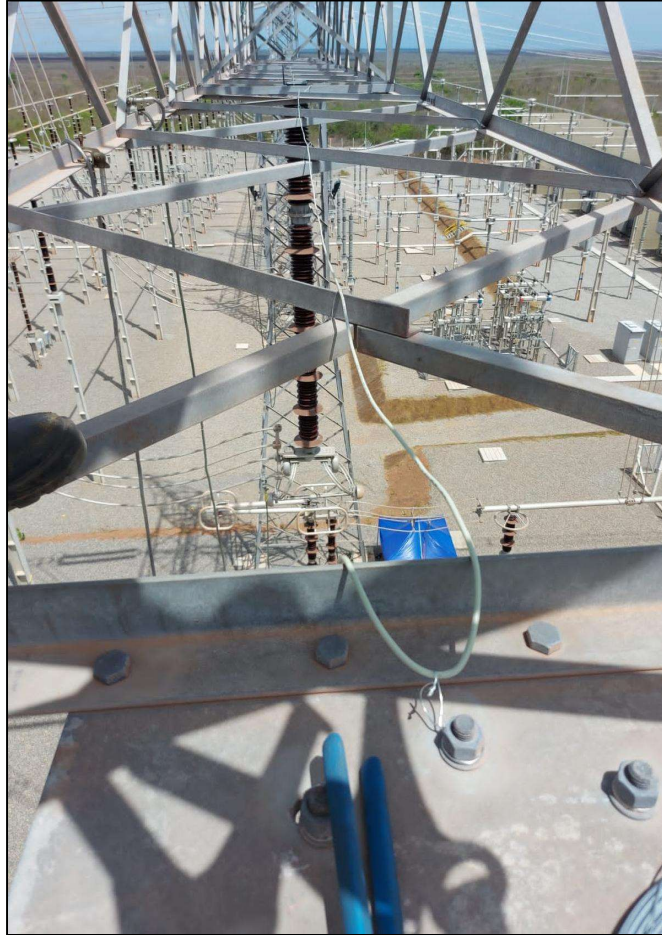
Detalhe do cabeamento utilizado para a instalação do protótipo do sensor no arranjo das chaves seccionadoras.
